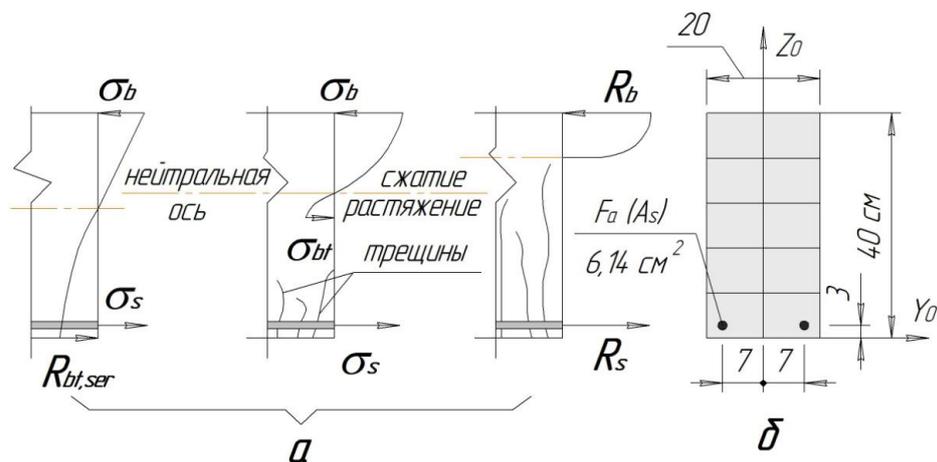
Стадии нагружения изгибаемой железобетонной балки: начальная, промежуточная, финальная (а) и моделирование сечения балки при компьютерном расчете (б)
